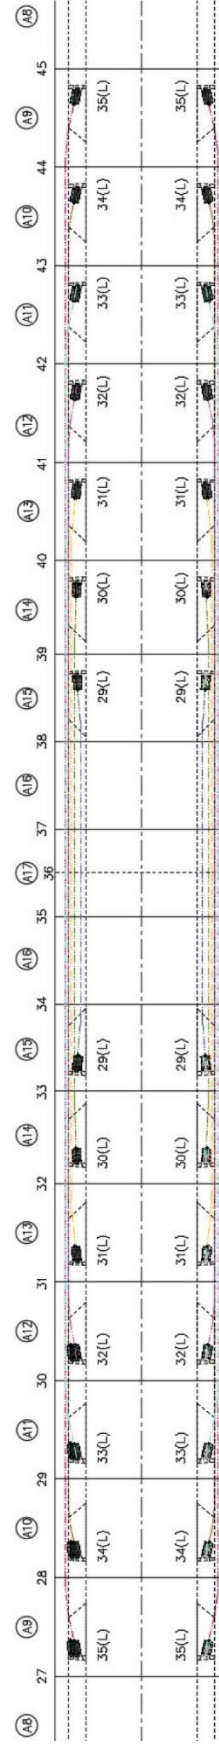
Üçgen kısımdaki üstyapı altında bulunan ardgerme halatlarının plan görünümü
